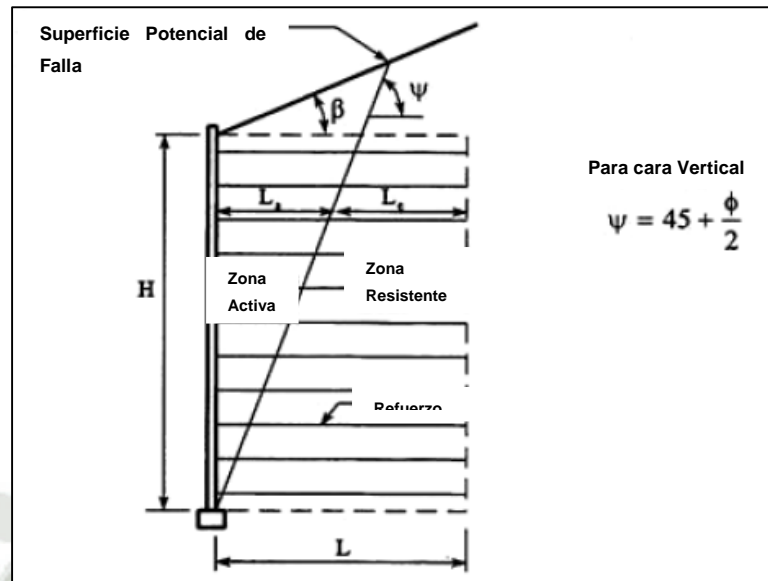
Superficie de Falla en Refuerzos Extensibles (FHWA-NHI-10-024, 2009)
